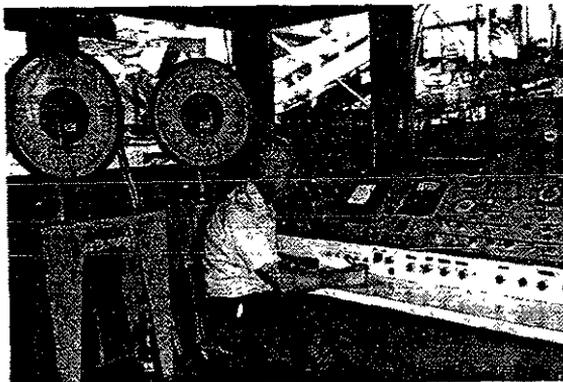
Mesa de control de una planta automática de dosificación.
